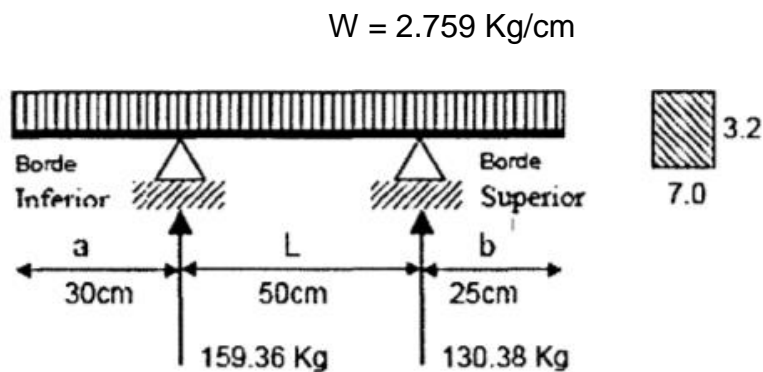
MODELACION DE LAS VIGAS CON LAS CERCHAS
